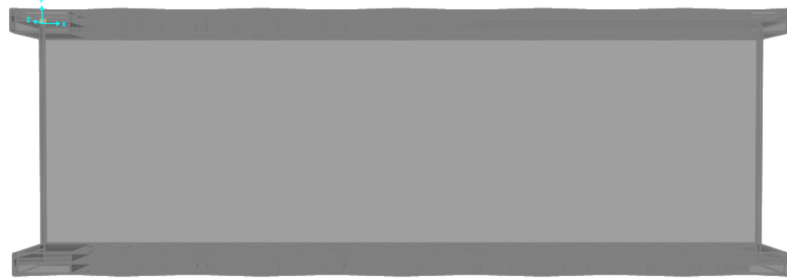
Planta pasarela de hormigón armado in situ. (Fuente: elaboración propia en SAP2000).
